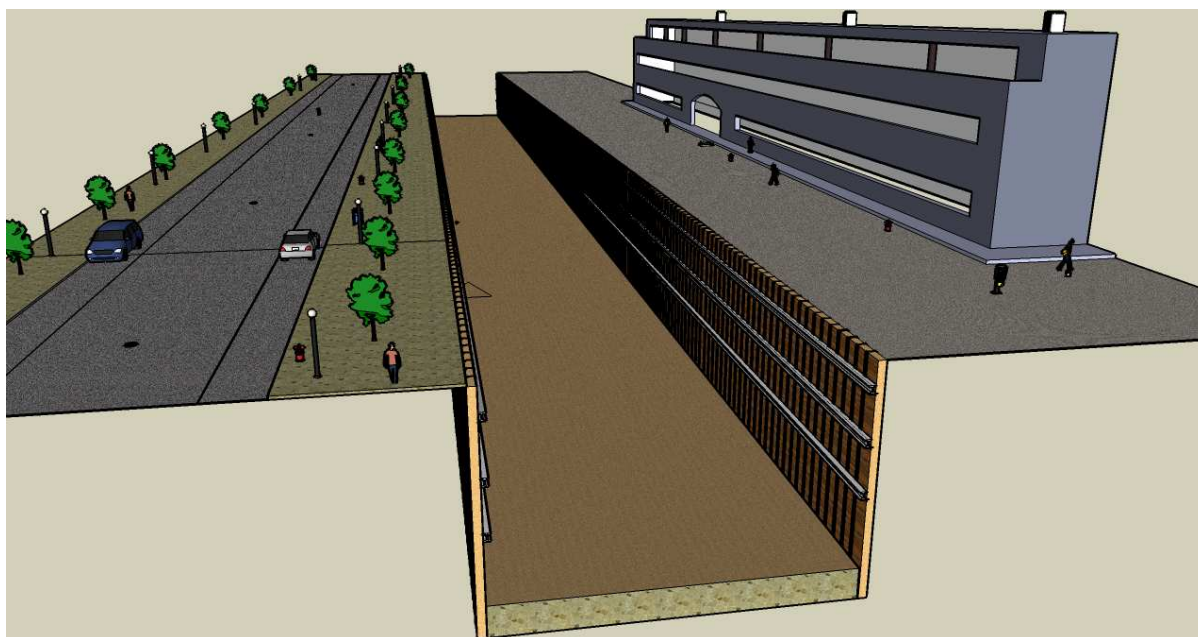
Desenho esquemático da fase de escavação e execução da cortina
